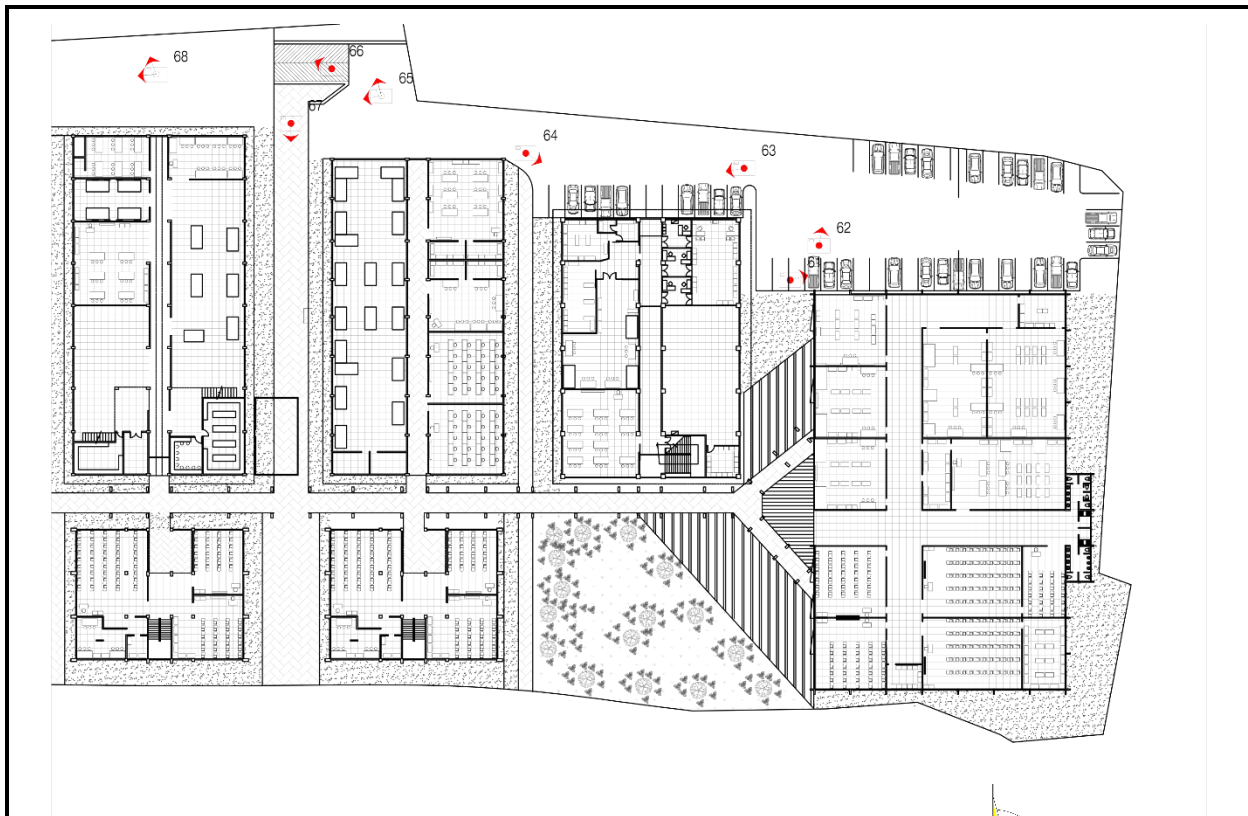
PLANTA DE PRIMER SECTOR DE PARQUEOS
